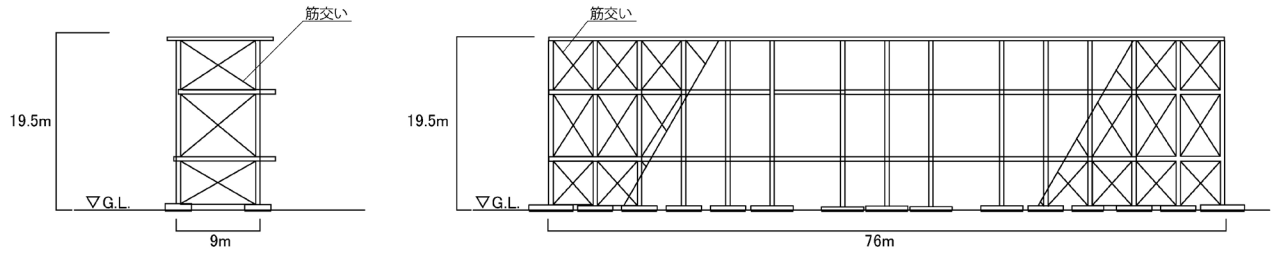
(1) 断面図 (A 設備架台、B 設備架台、F 設備架台)
